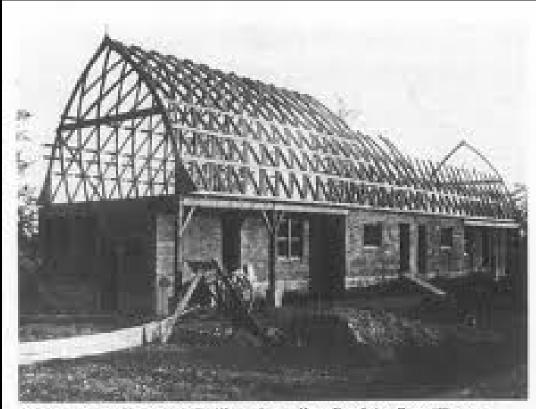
Doppelhaus mit Zoilbau-Lamellen-Dach im Bau (Gensaer Straße, Merseburg 1922) Fig. 4. Semi-detached house with "Zollbau-Lamellen" roof under construction
